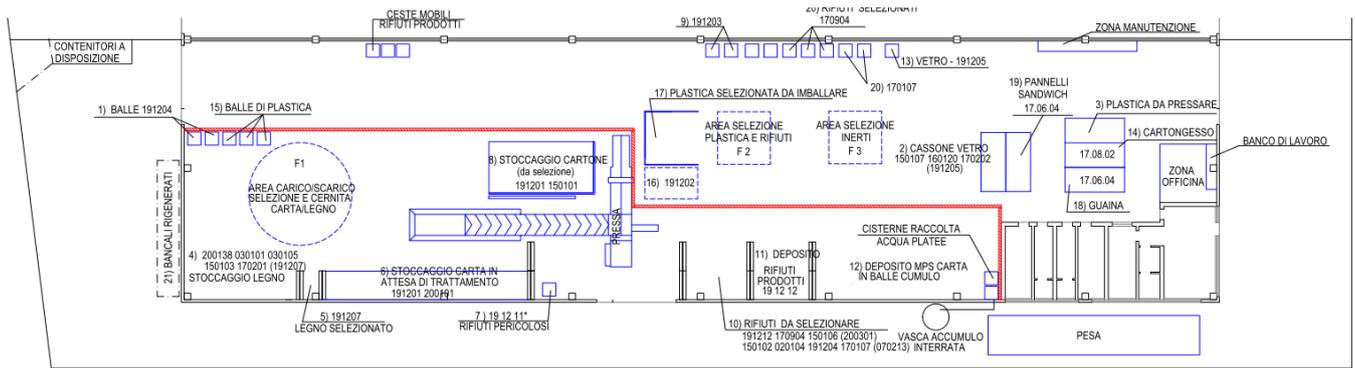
LAYOUT DI PROGETTO DELL'IMPIANTO AZIENDALE.
